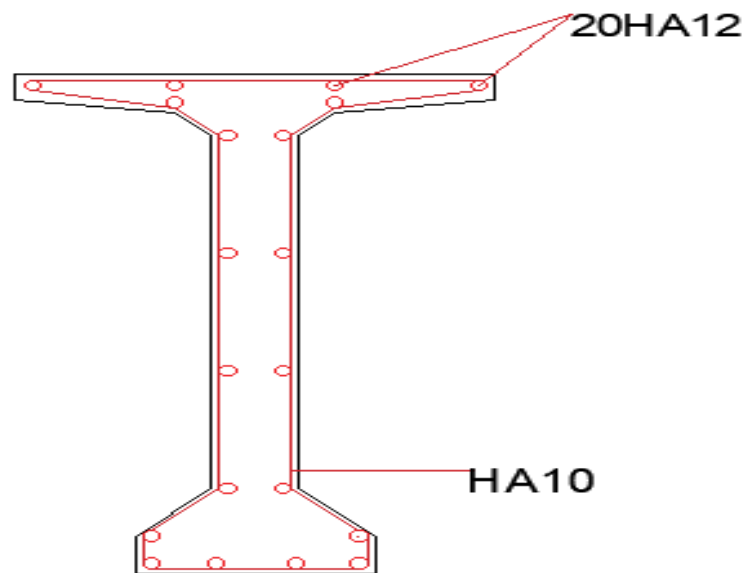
Ferrailage de la poutre (Section Médiane)
